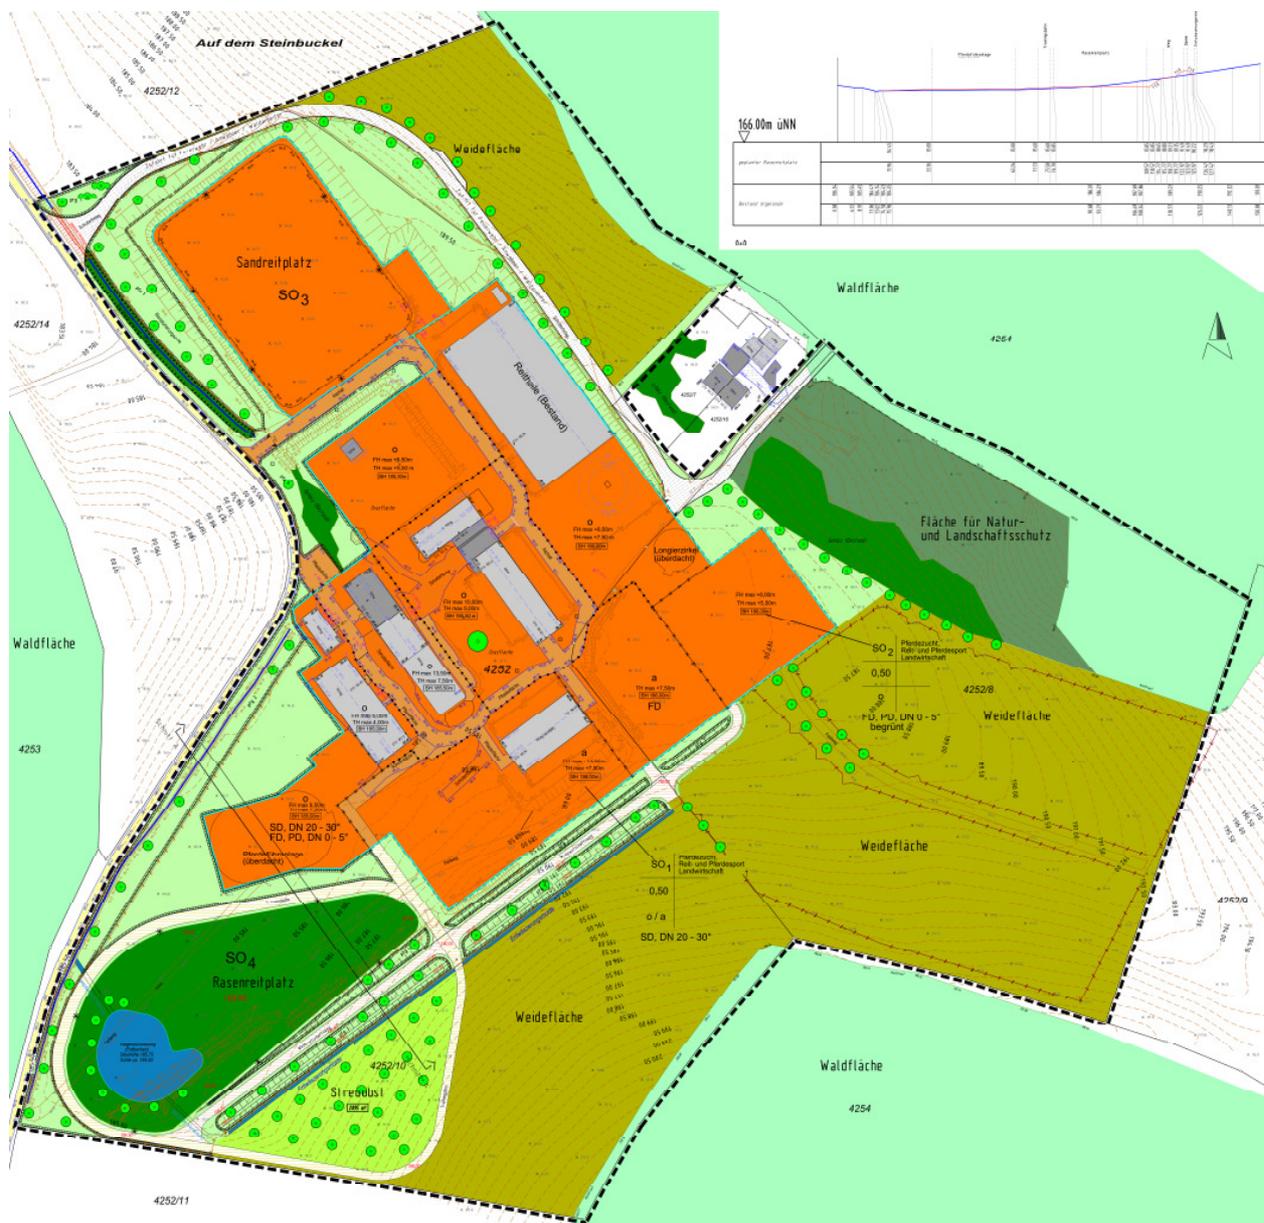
Entwurf Bebauungsplan, Stand 10.07.2019
